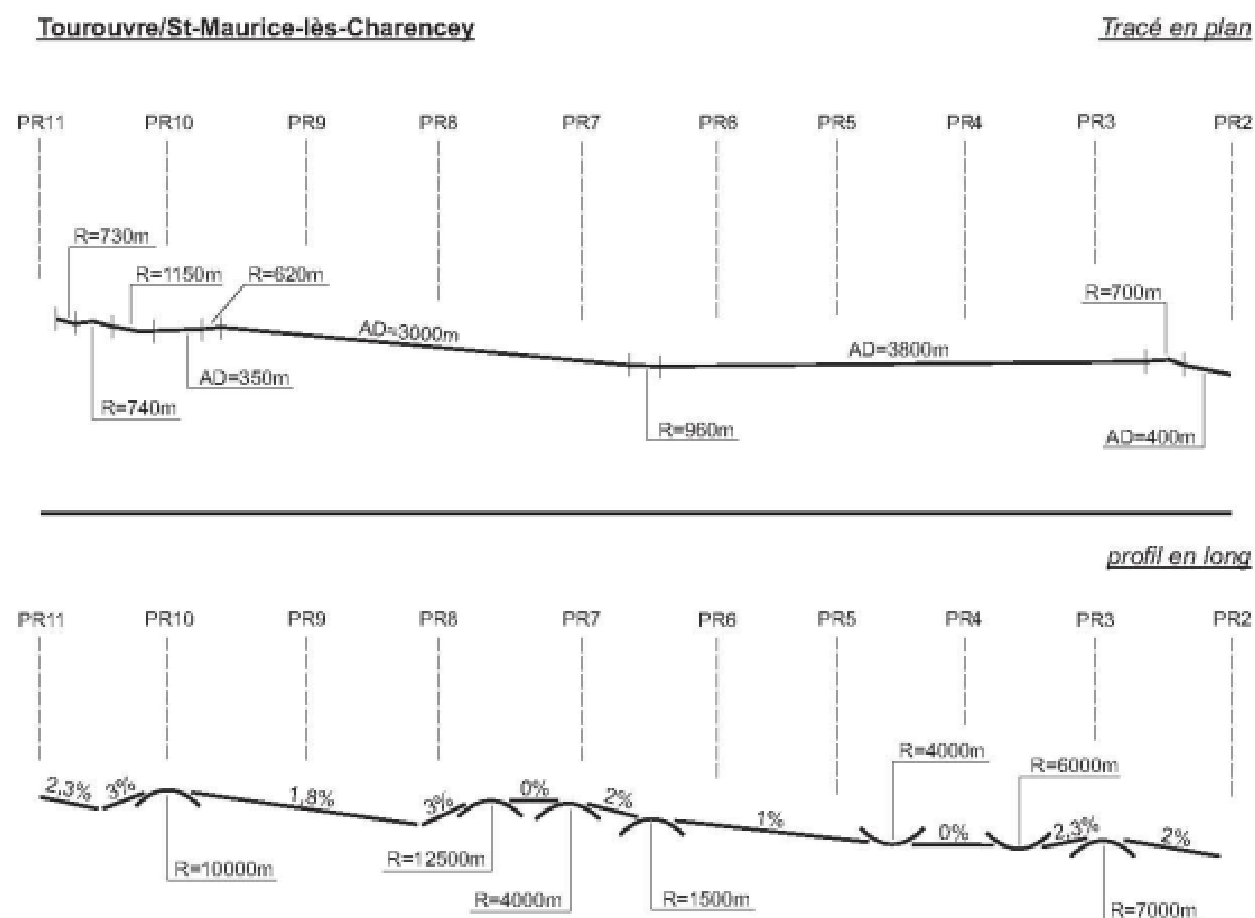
Axe en plan et profil en long de la section (source: SEGIC)
